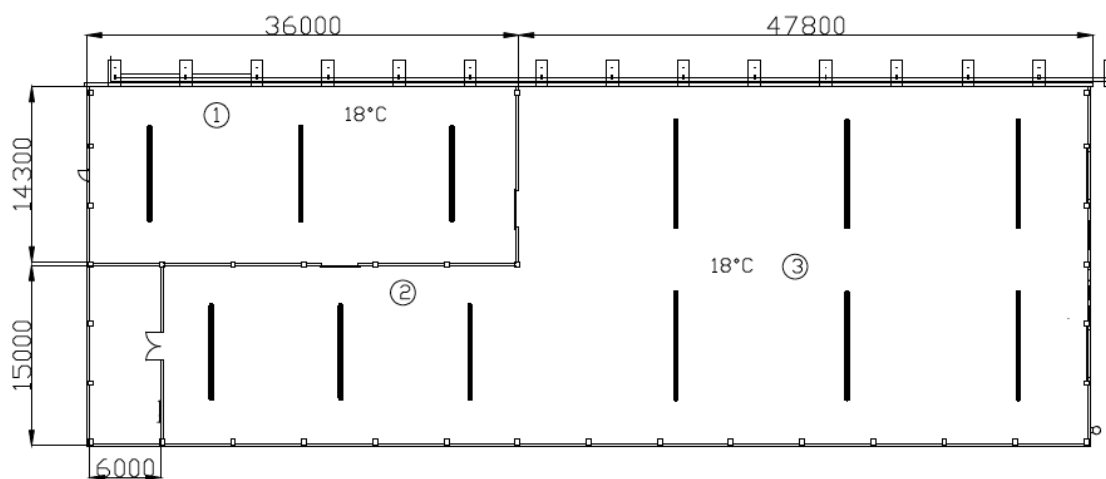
Návrh a rozmístění panelů Mandík Hala 3 [P3]
